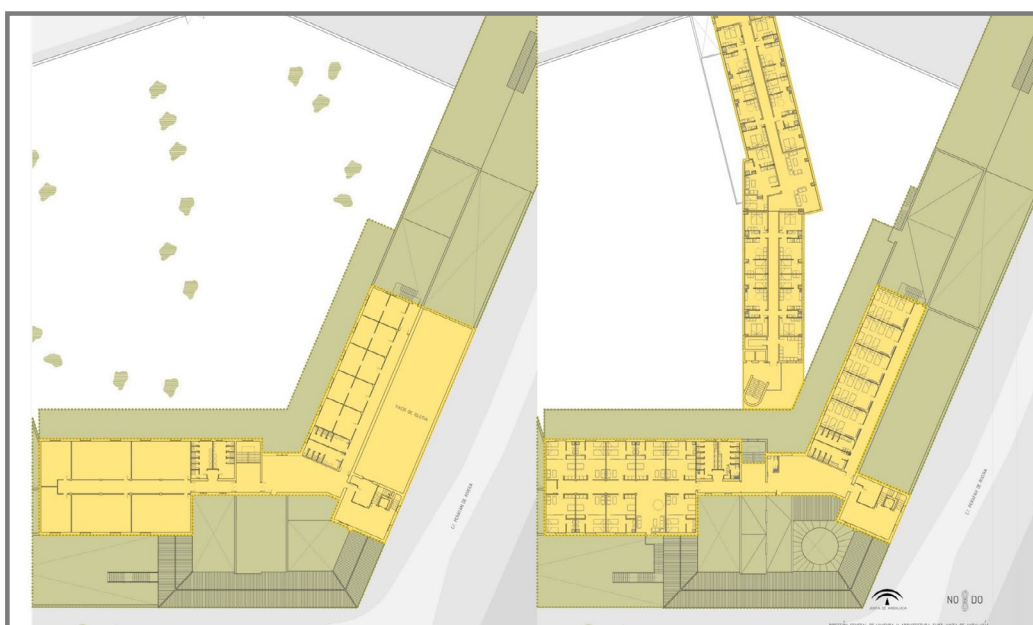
Zona de la planta segunda en la que se desarrollan los apartamentos para una familia con cuatro miembros organizados en dos dormitorios dobles.
